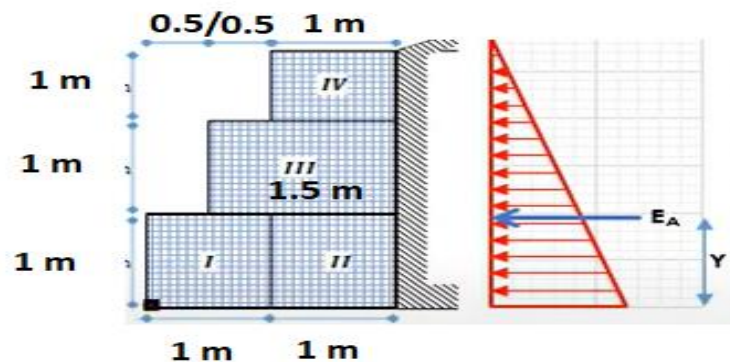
Diseño de segmento para muro de gaviones en calle Paraíso, con detalle de fuerzas aplicadas
